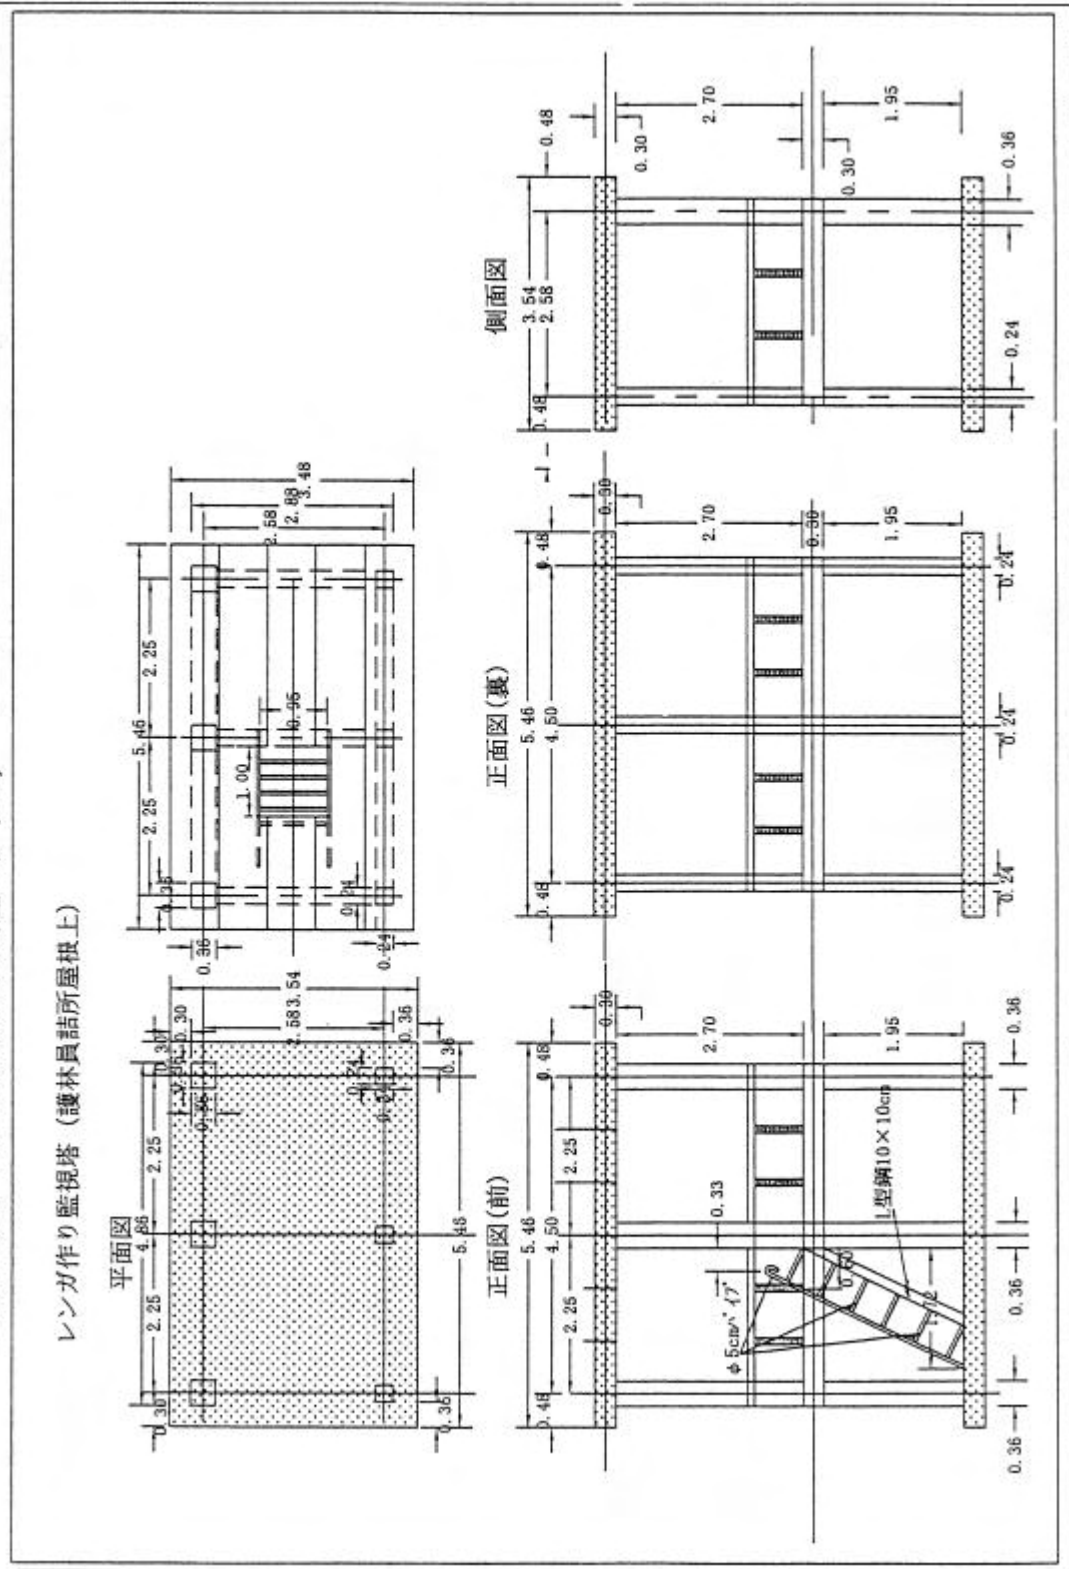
監視所正面、平面図（護林員詰所屋上タイプ）
